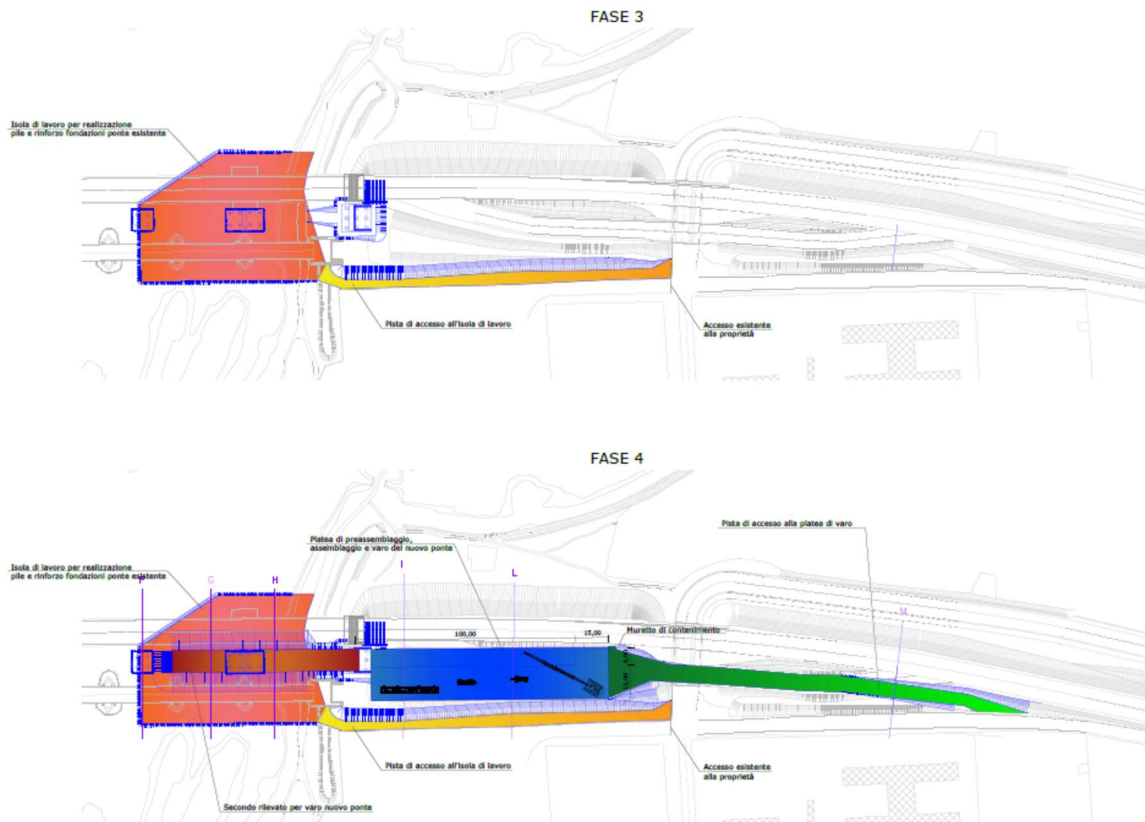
Cantiere sponda cremonese (Fase 3-4)
